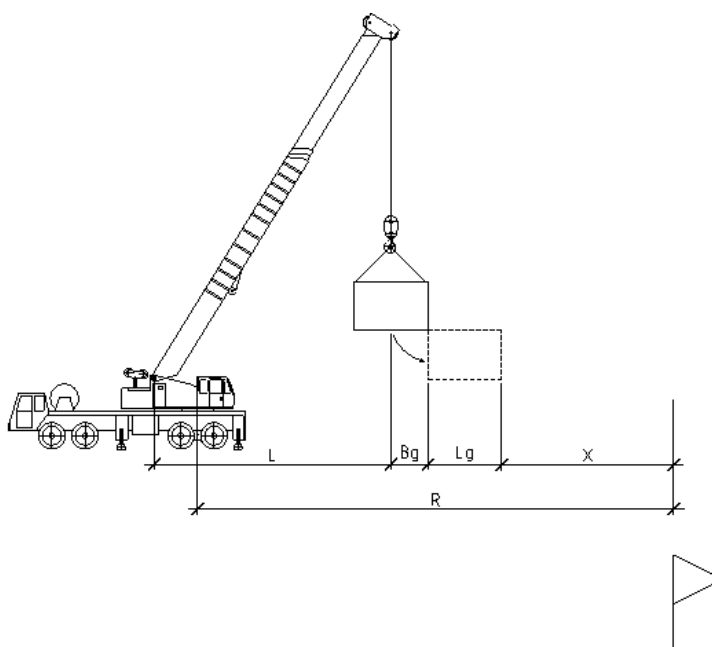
Расчет границ опасной зоны при перемещении грузов кранами
